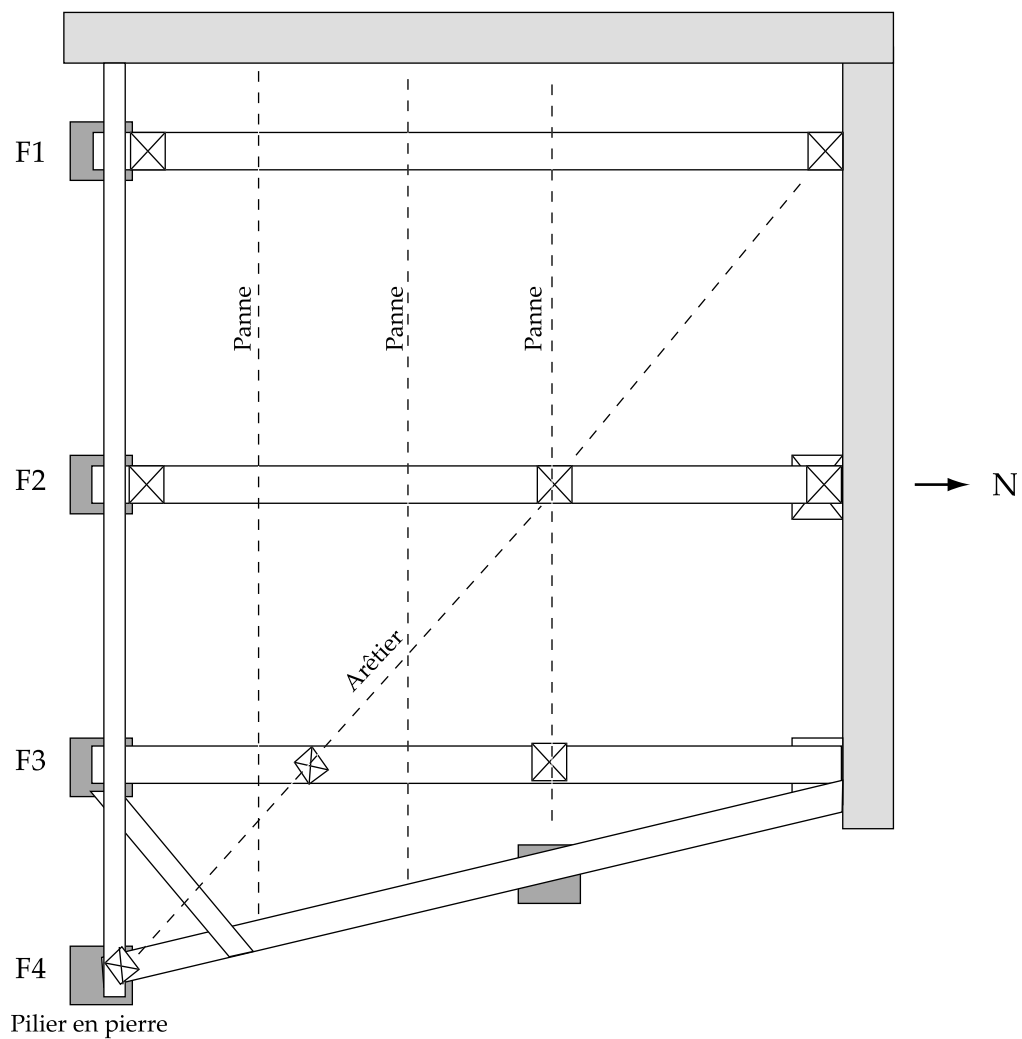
Plan schématique de la halle, au niveau de la charpente.
